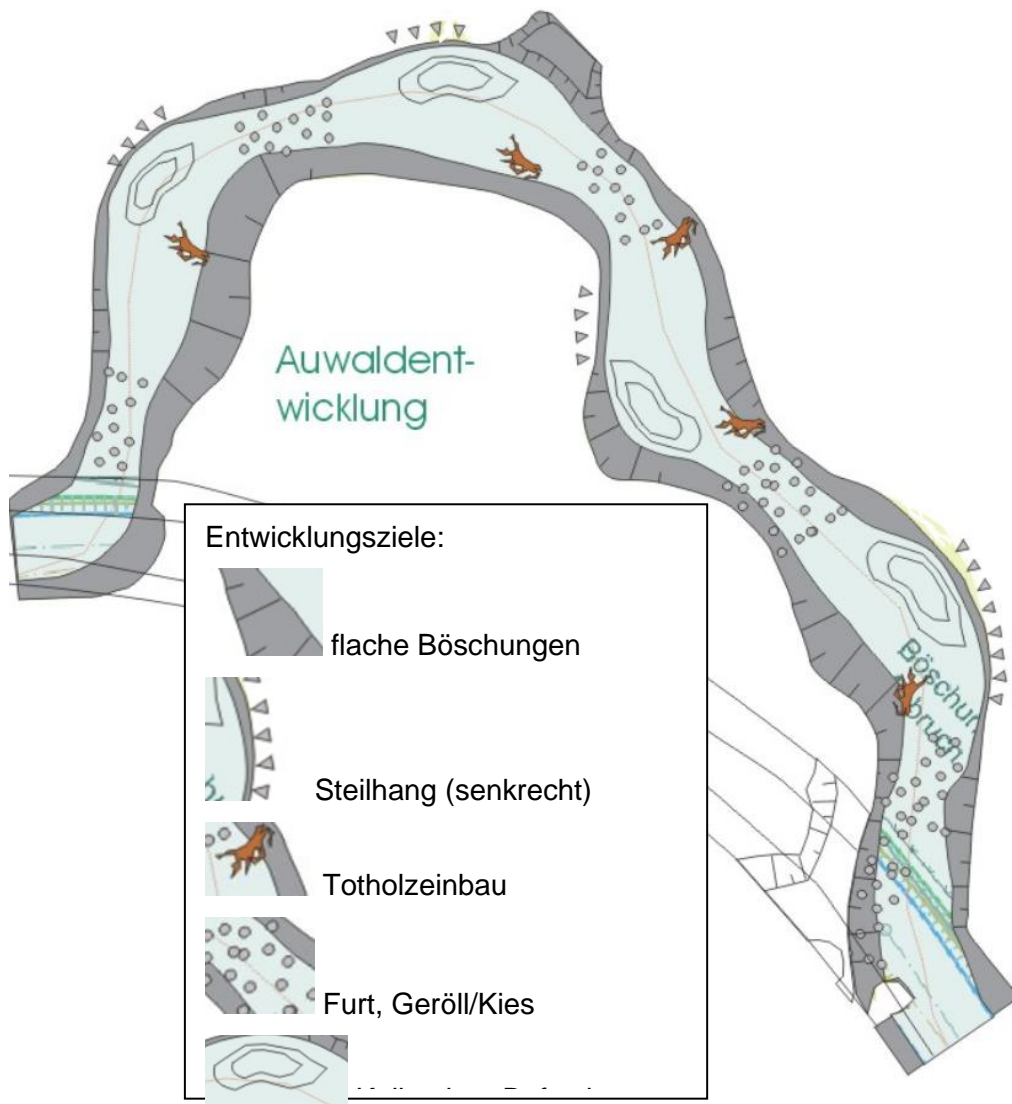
Detaildarstellung der geplanten Gewässerstruktur (s. auch Plan 2 Maßnahmen)
